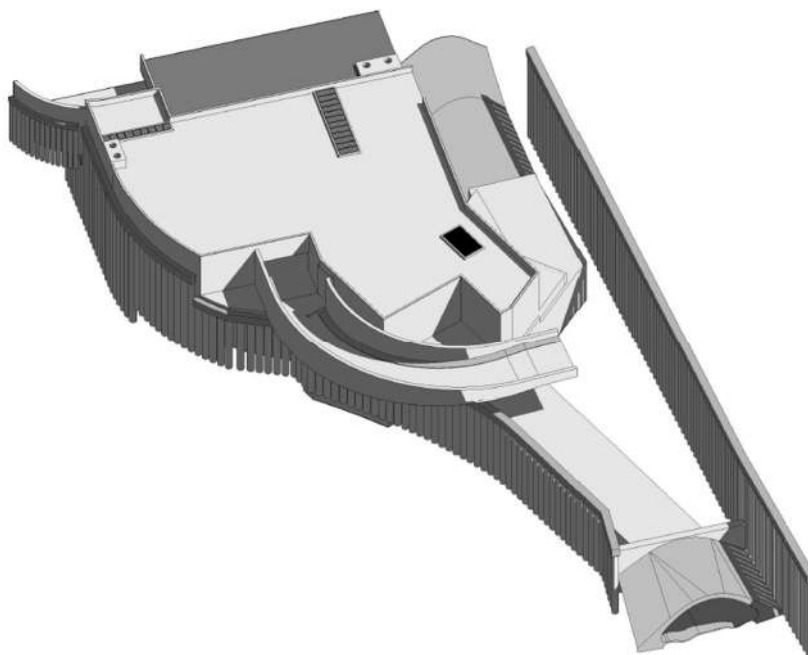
Imagem 3D da estrutura P02 – Alçado Oeste
